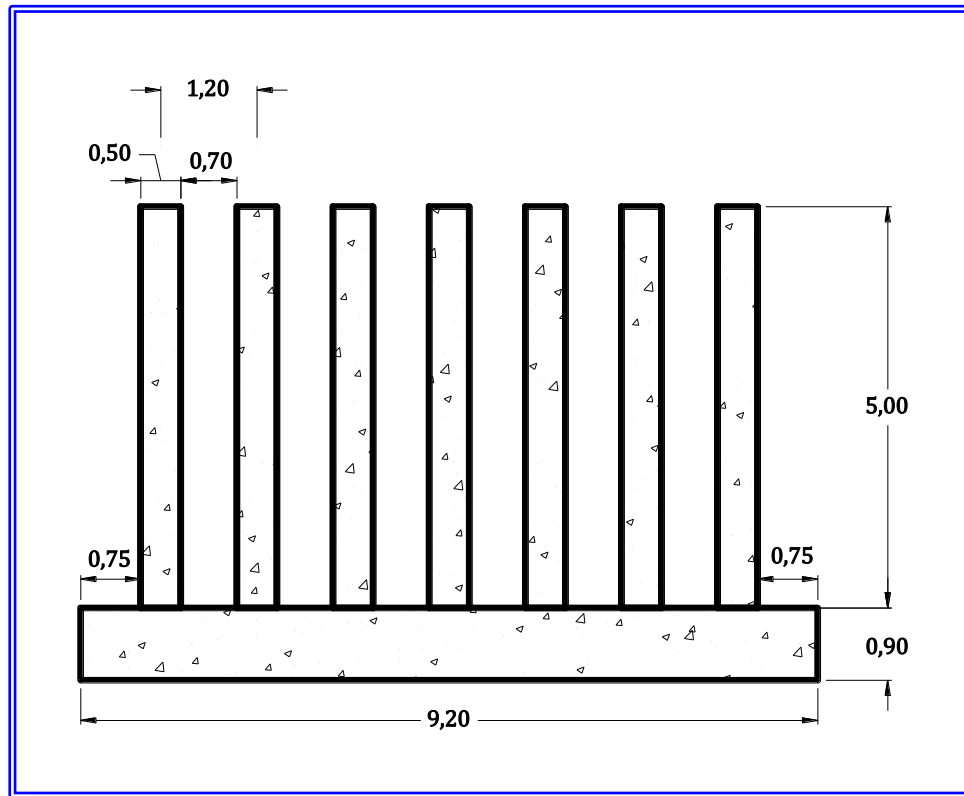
Vista frontal de presa con diente de 5 metros sin viga de amarre.
